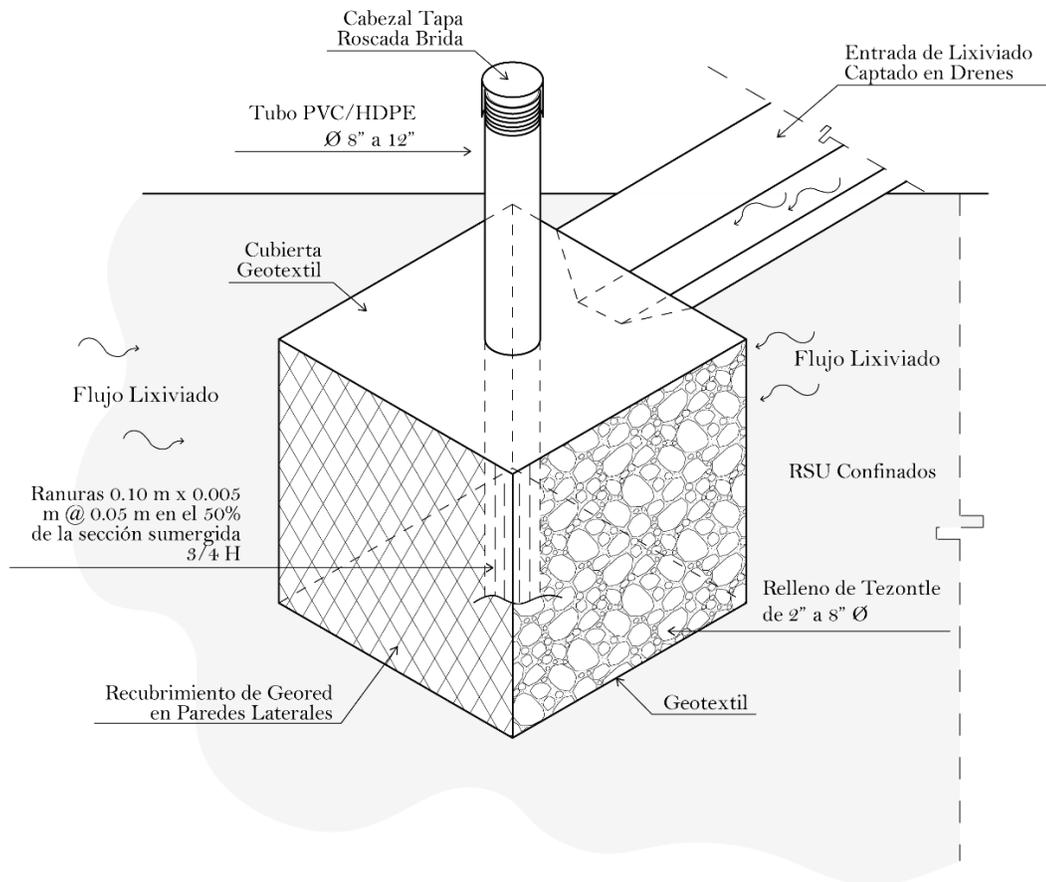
Diagrama de cárcamo simple con refuerzo de geored, filtro de tezontle y cubierta de geotextil para la captación de lixiviado
